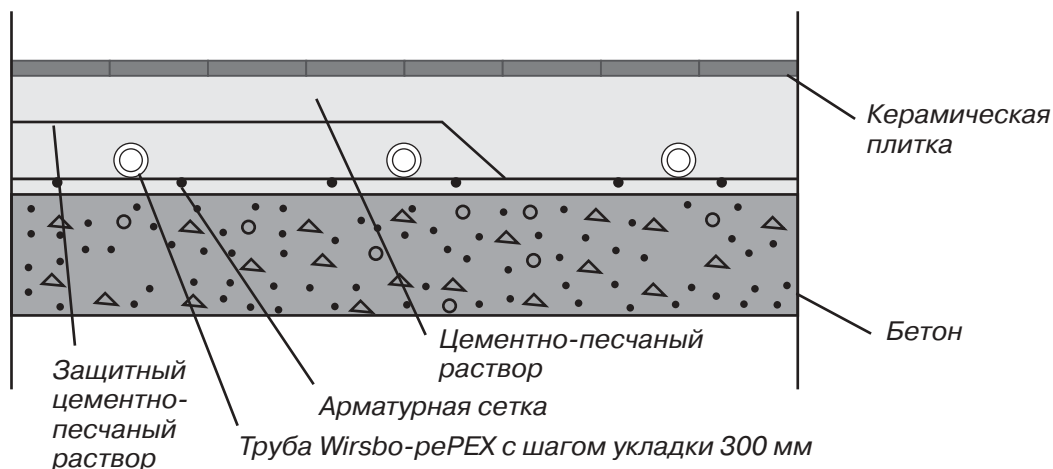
Монолитный пол на бетонной плите. Петли трубы уложены на сетке и закреплены при помощи крепежной проволоки до бетонирования.
